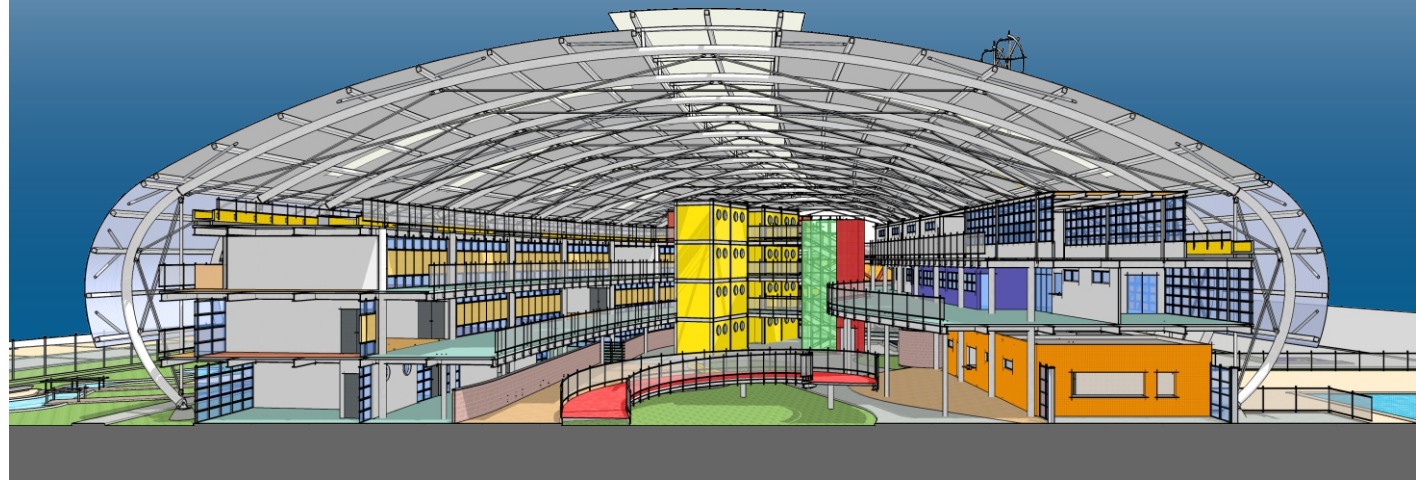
Plantas e corte explicando a estrutura de lajes steel deck com perfis "I" ligados aos pilares e pórticos. Fonte: elaborado pelo autor
